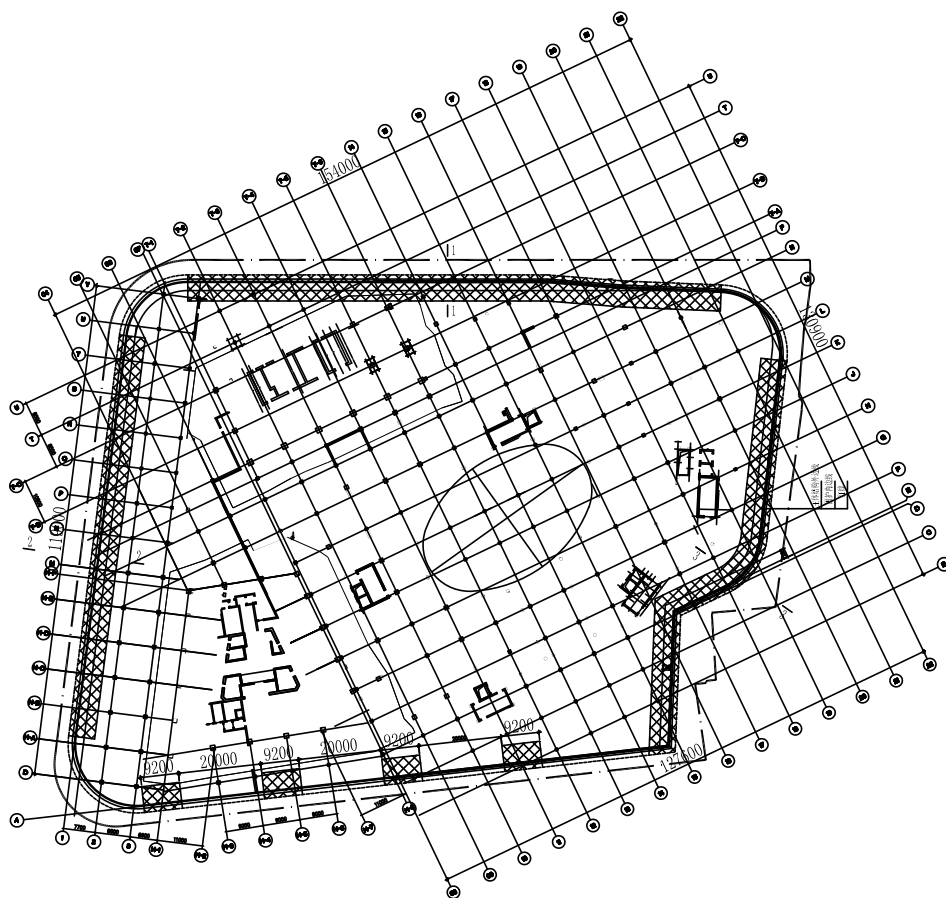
鹏欣家纺中心基坑土体加固平面图
